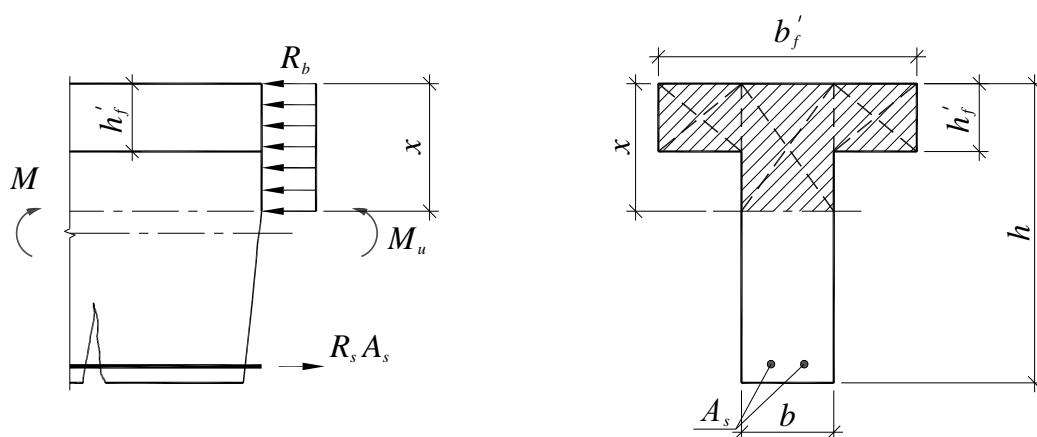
К расчету тавровых сечений, когда нейтральная ось пересекает ребро.
